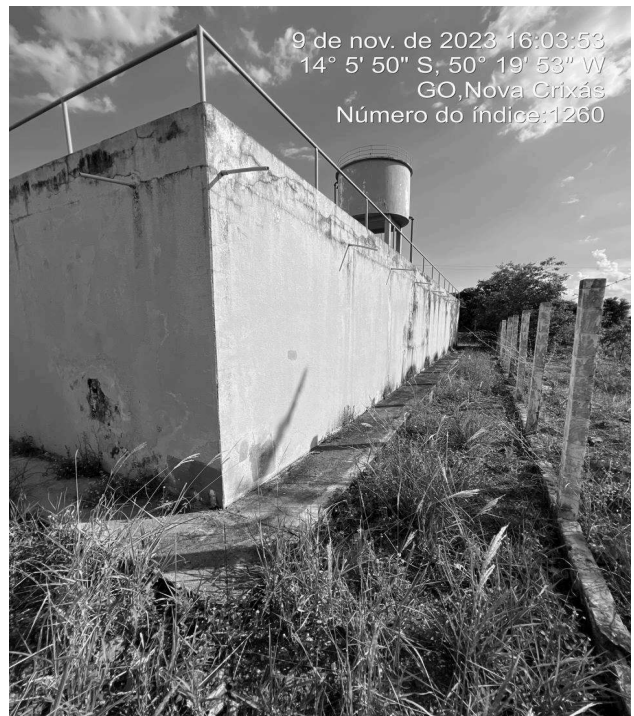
RAP/ETA Semi enterrado 660 m³,
